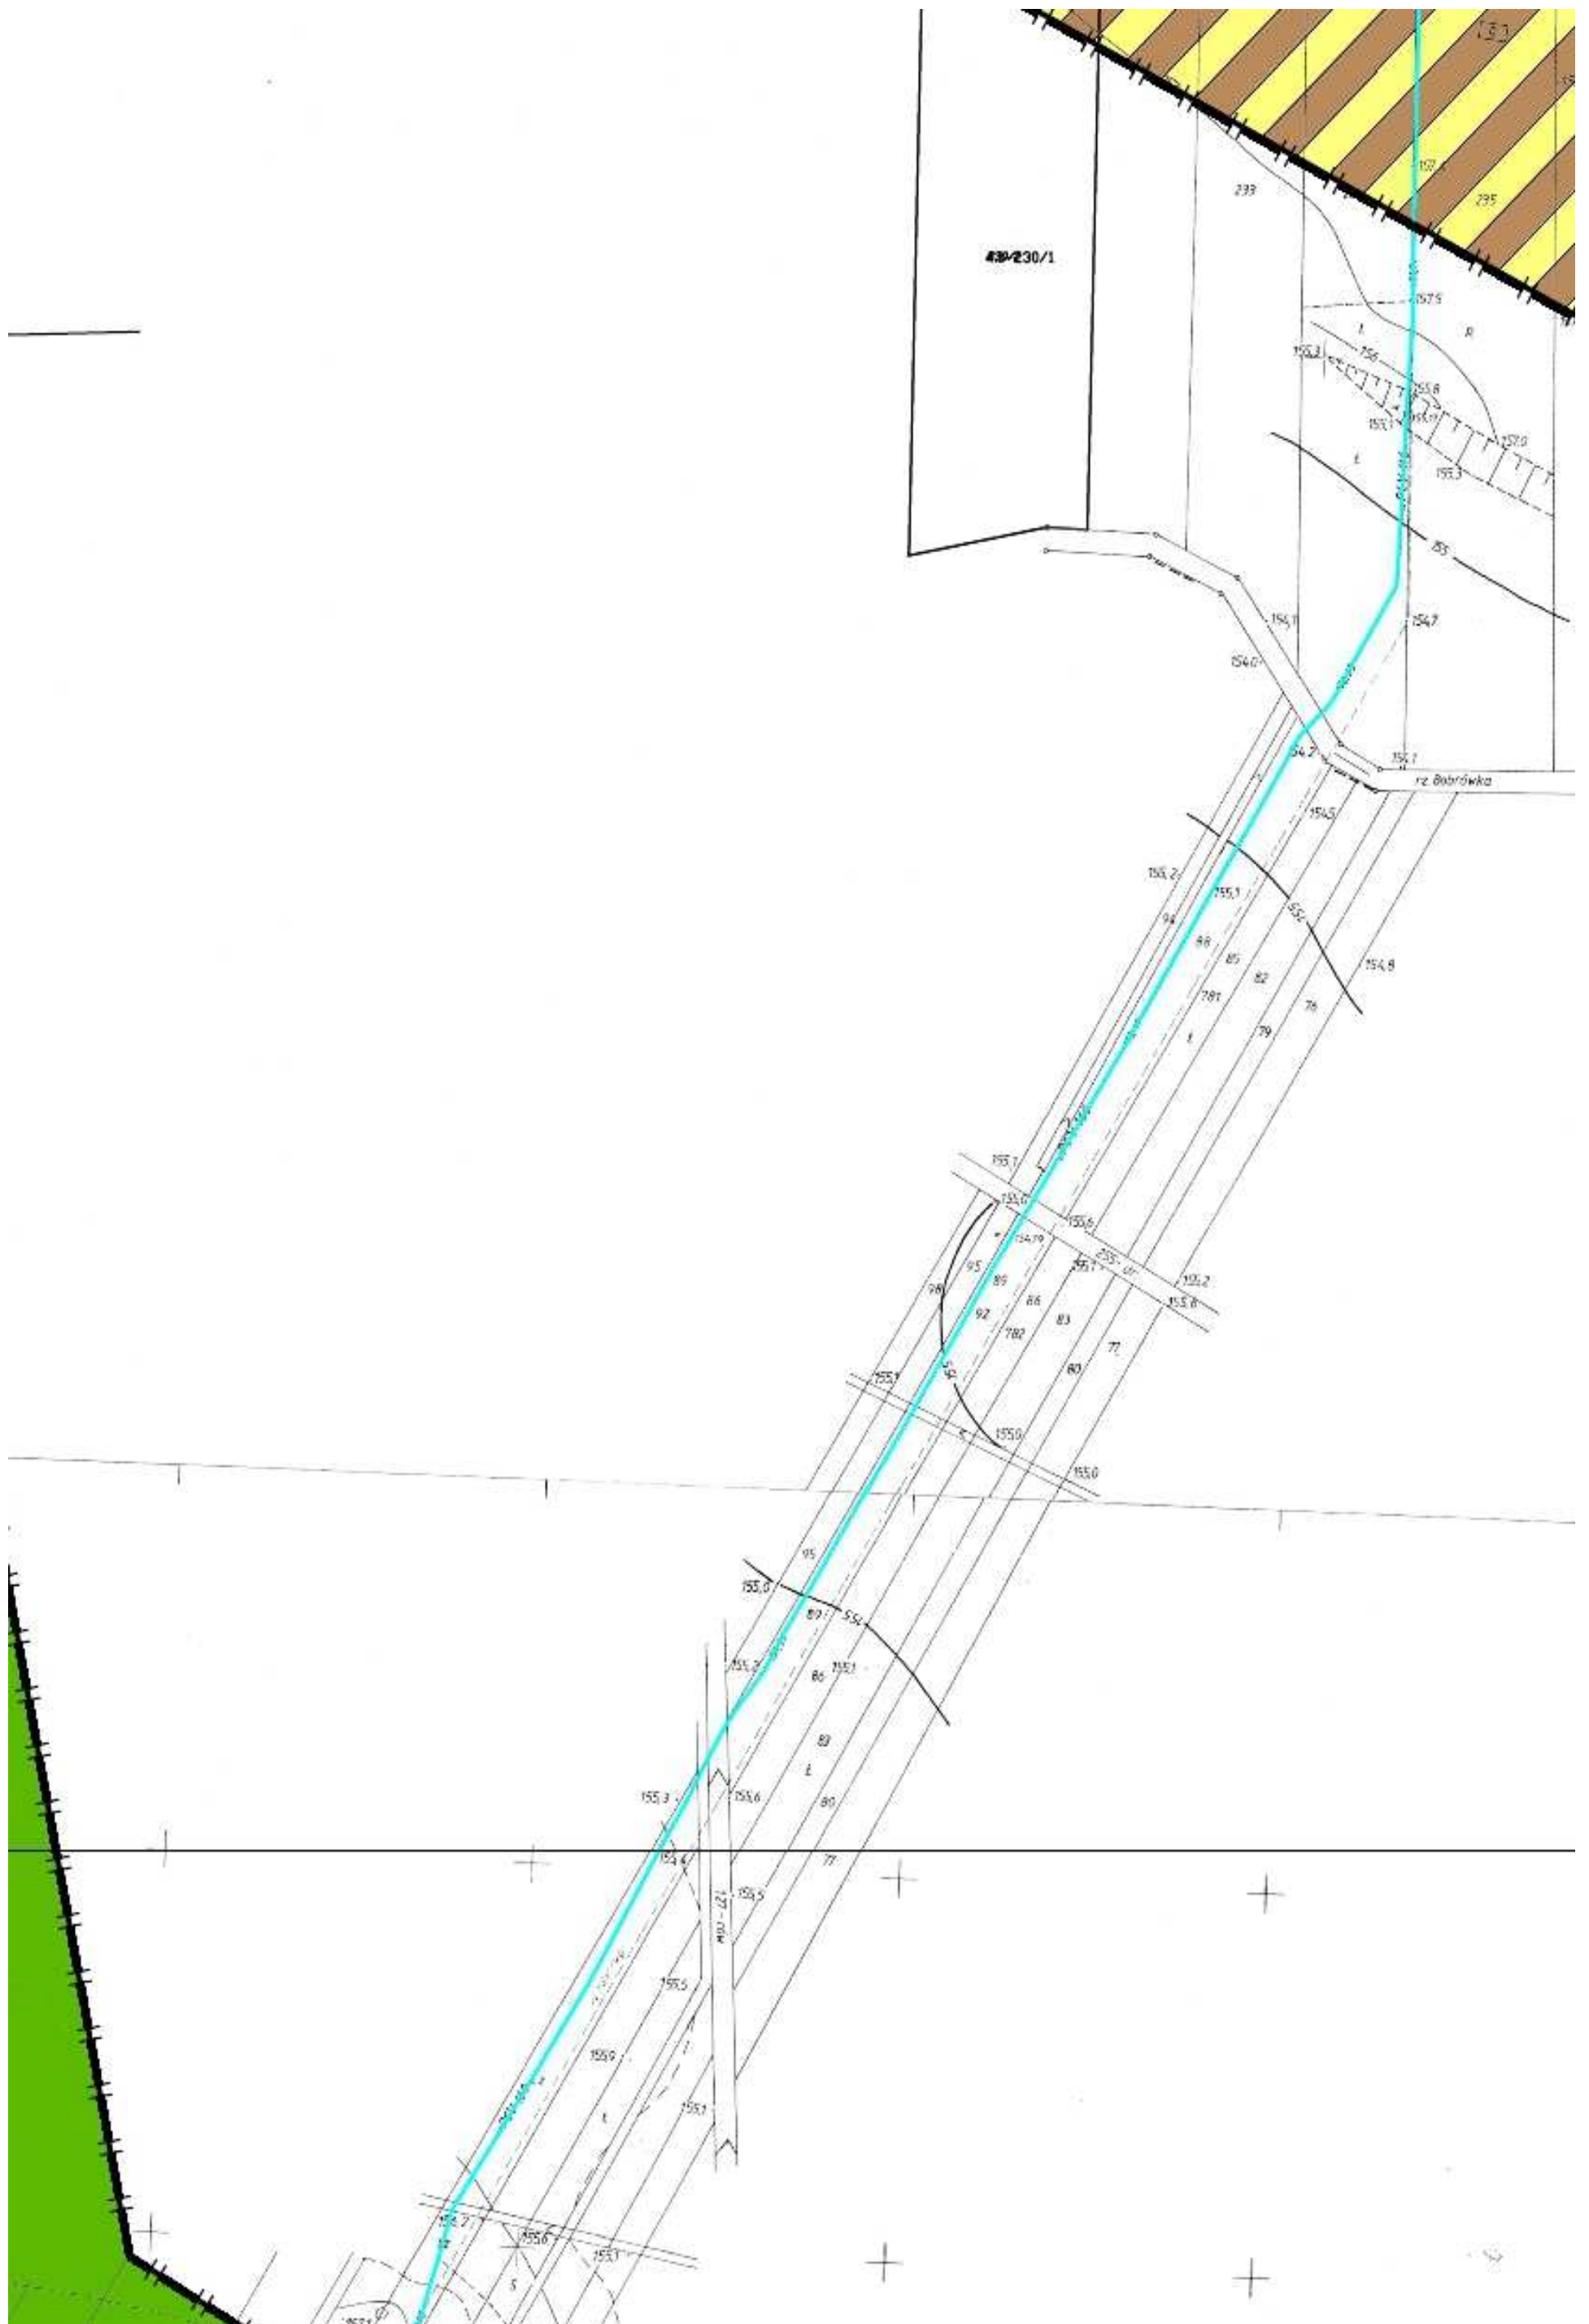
KIERUNKI PLANSZA ZBIORCZA
